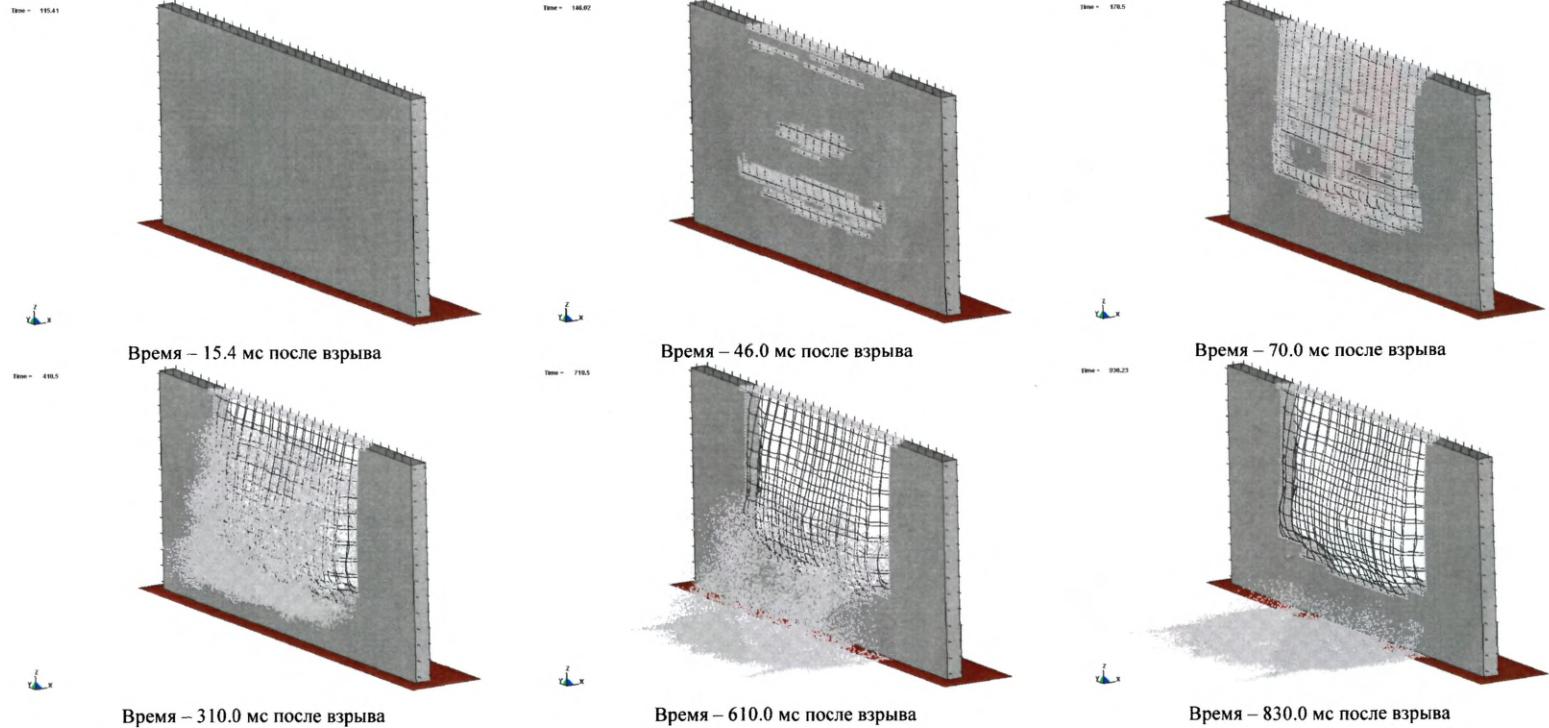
Фрагментация железобетонной стены при разрушении
